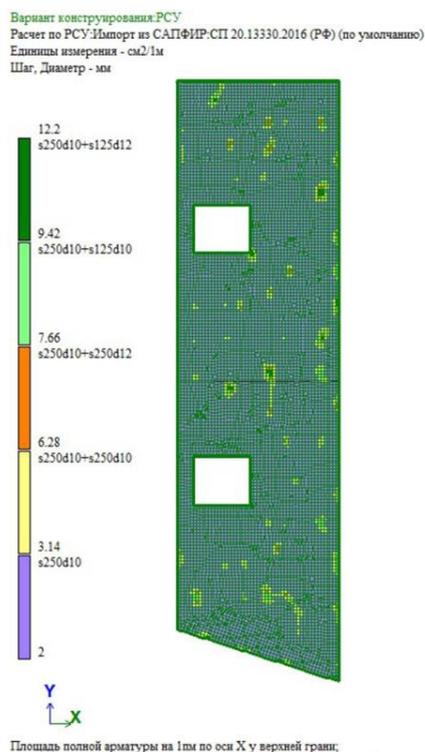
Армирование по оси X у верхней грани (см<sup>2</sup> на 1 м.п.)
